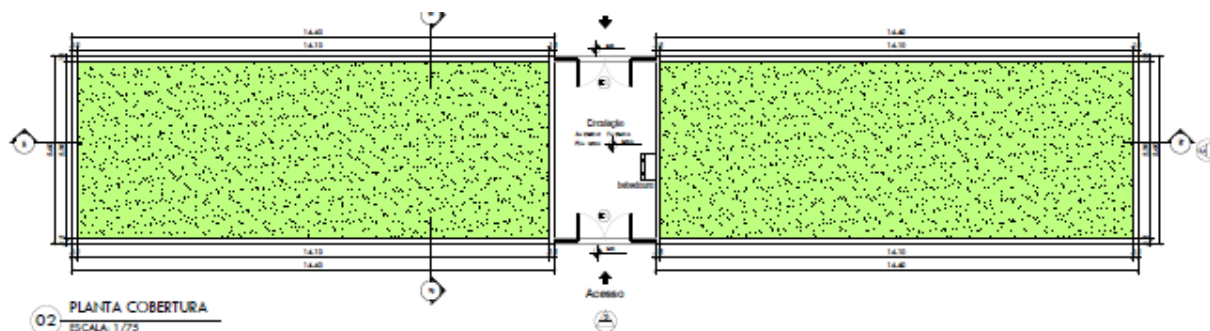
Telhado Verde – planta SNR-2018.043-PQO-DE-A002-FL12-R00
